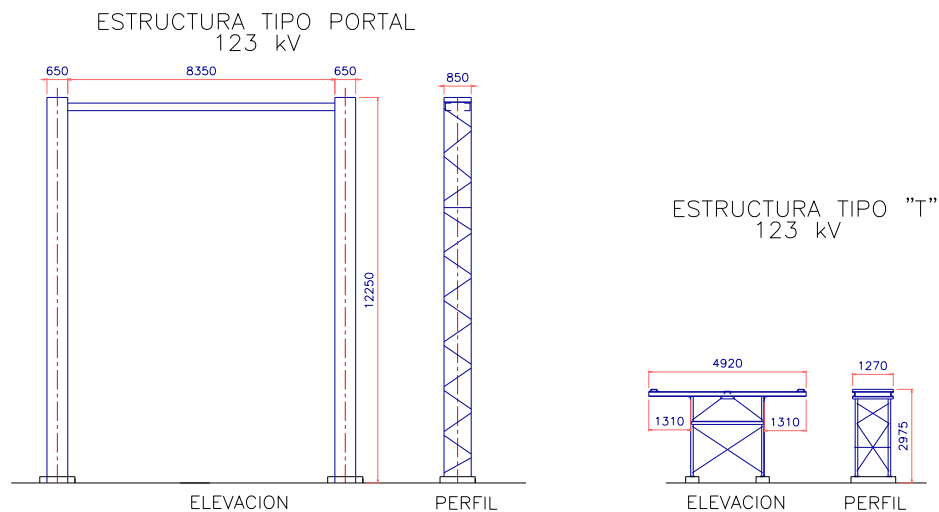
Estructuras Soporte Típicas para Seccionadores de 123 kV
